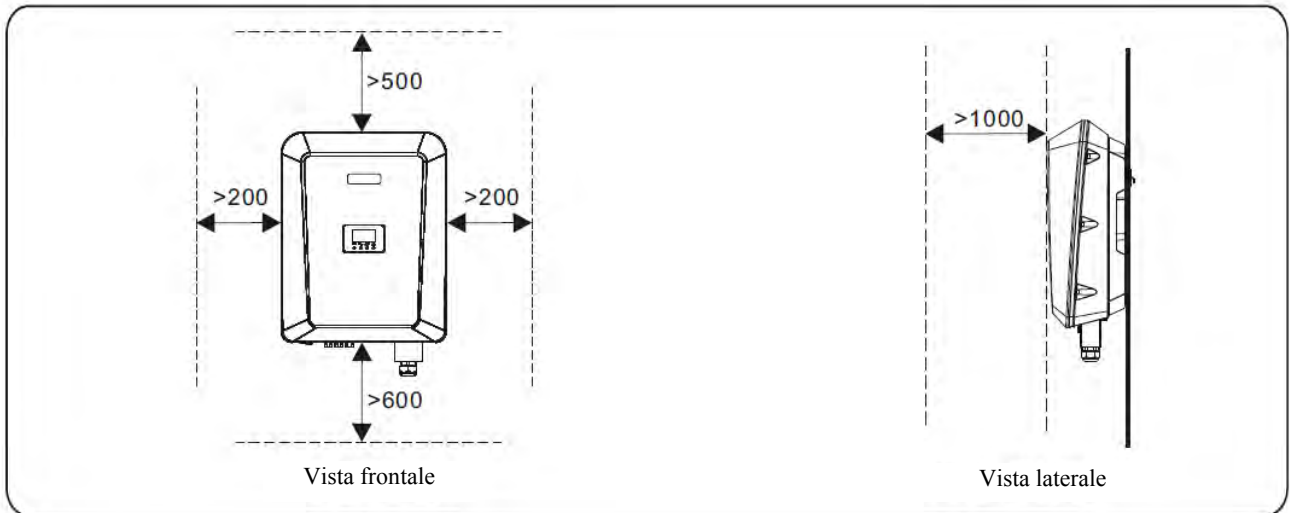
Requisiti di spazio per l'installazione (unità: mm)
